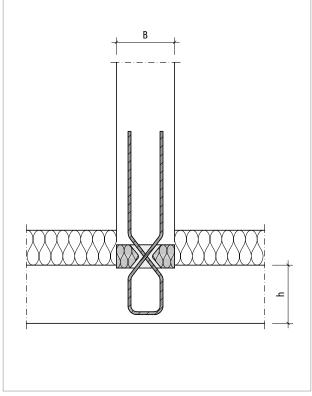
Schöck Sconnex® Typ W-N-VH: Statisches System
